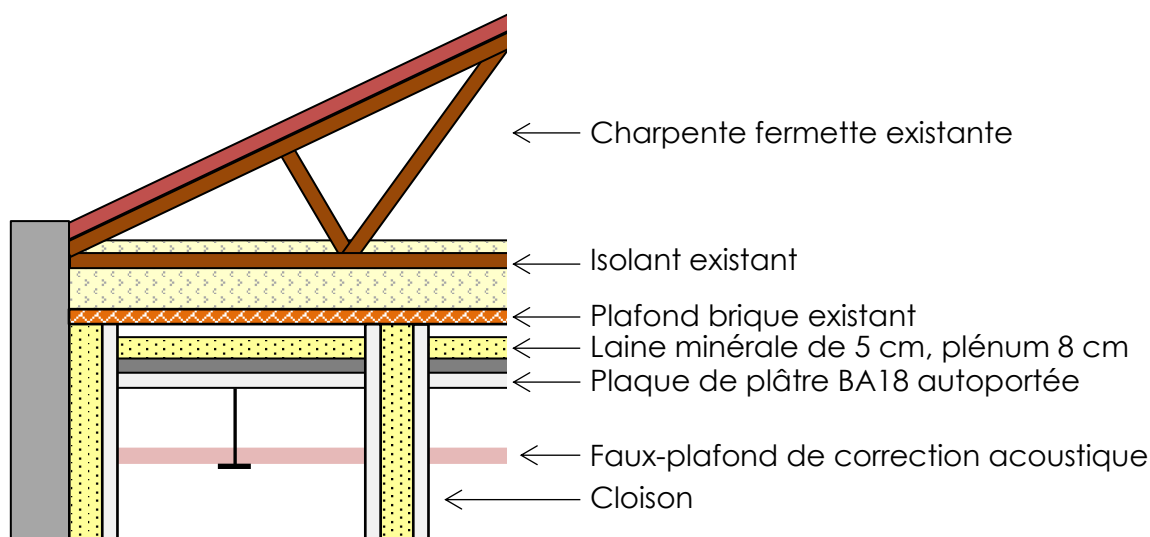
Schéma de principe en coupe – Complexe de toiture fermette
